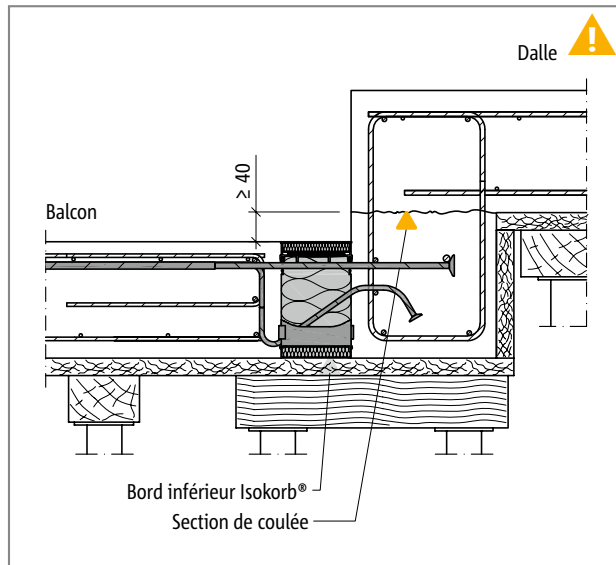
Schöck Isokorb® XT type K-U : Balcon en béton sur site avec décalage vertical vers le bas
